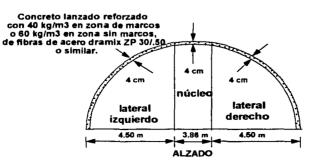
Colocación de una capa primaria de concreto lanzado con fibras de acero hasta alcanzar un espesor de 4 cm en los laterales y el núcleo.
